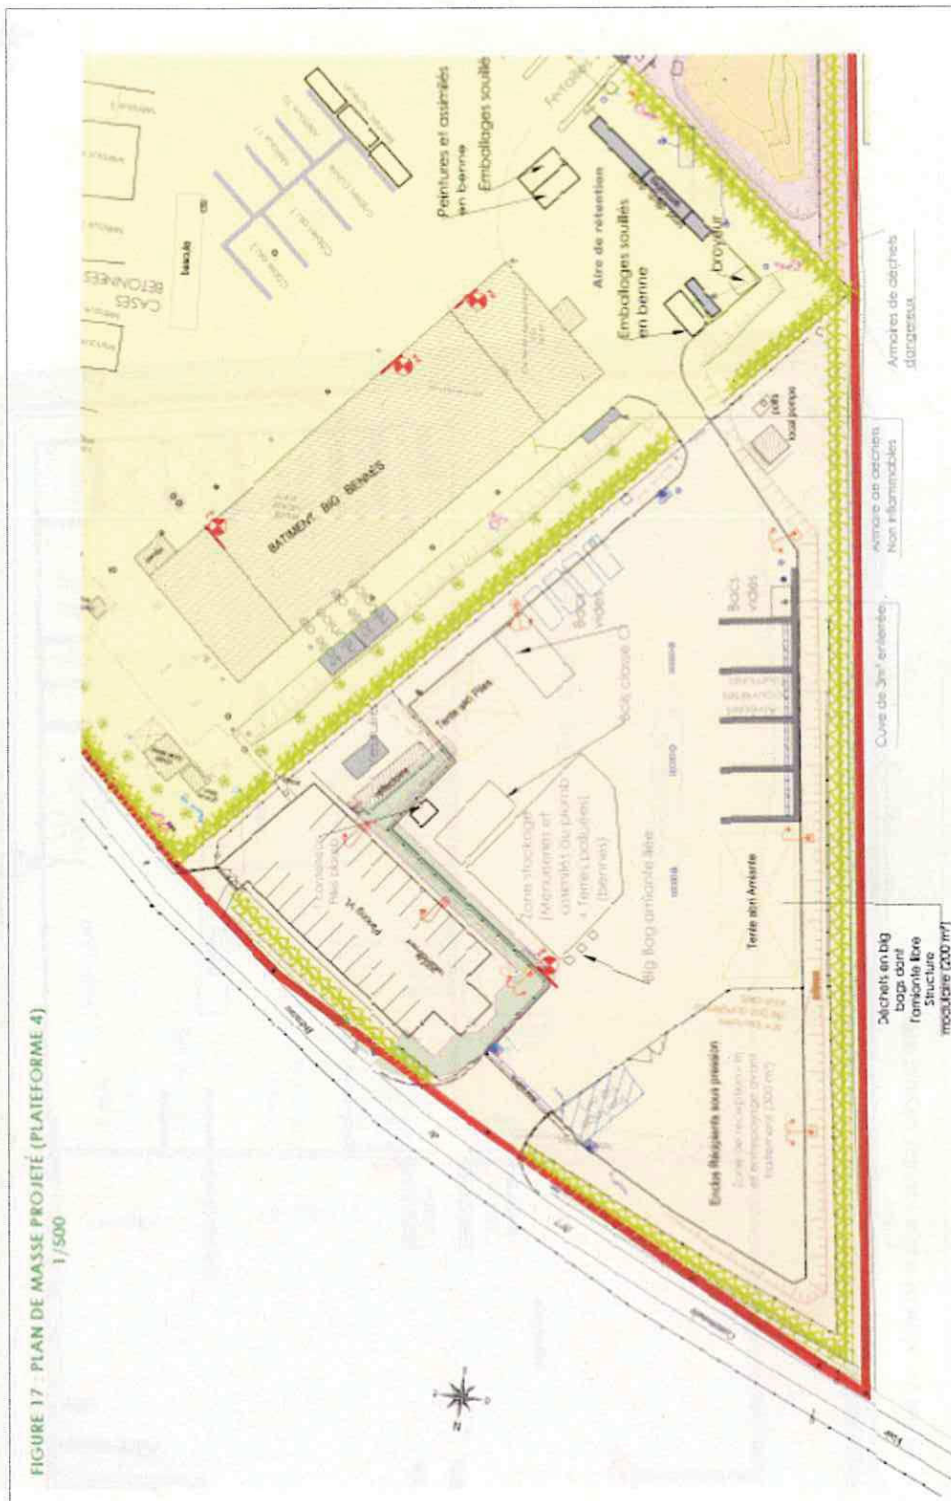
PLAN DE MASSE PROJETÉ (PLATEFORME 4)
